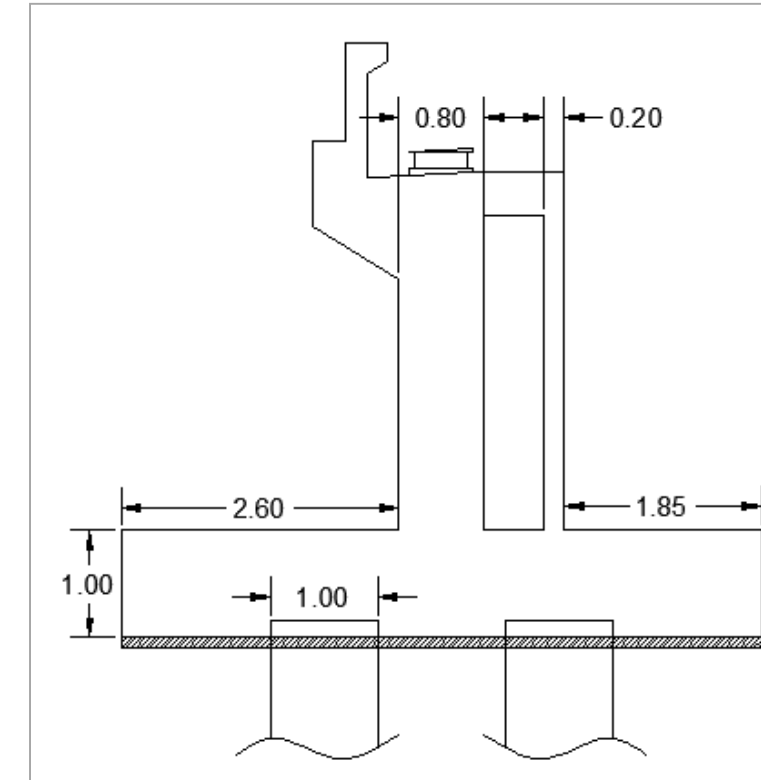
Sección indicativa de ambos estribos (norte y sur). Fuente: Elaboración propia con AutoCAD.
